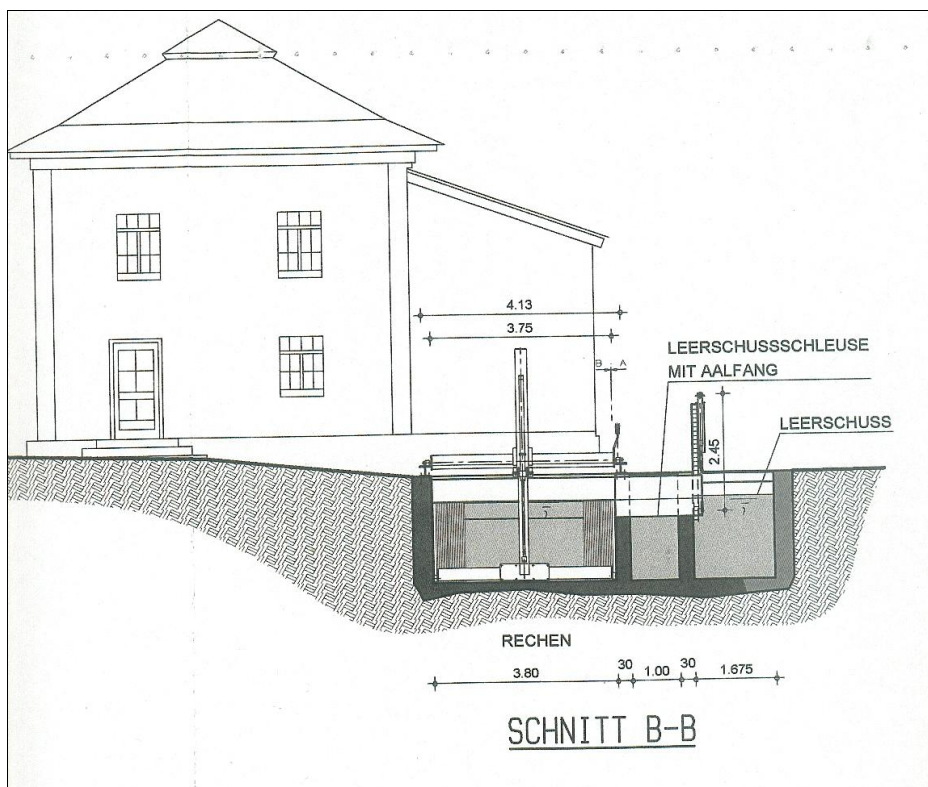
Schnittzeichnung durch die Rechenanlage, Quelle: Büro. Meier & Heuer
